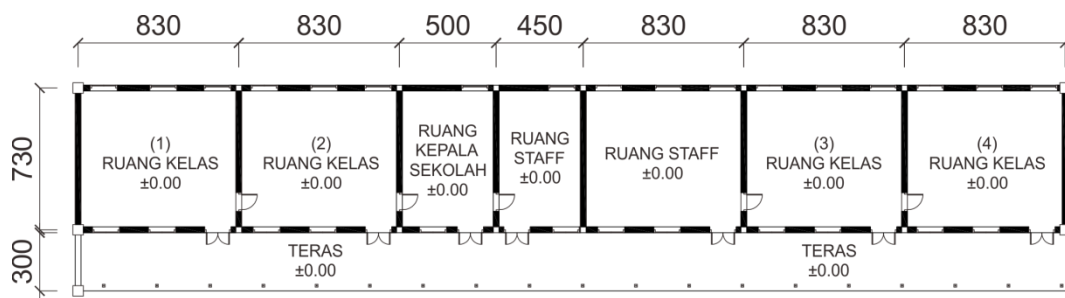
Massa Bangunan SMPN 3 Surabaya
